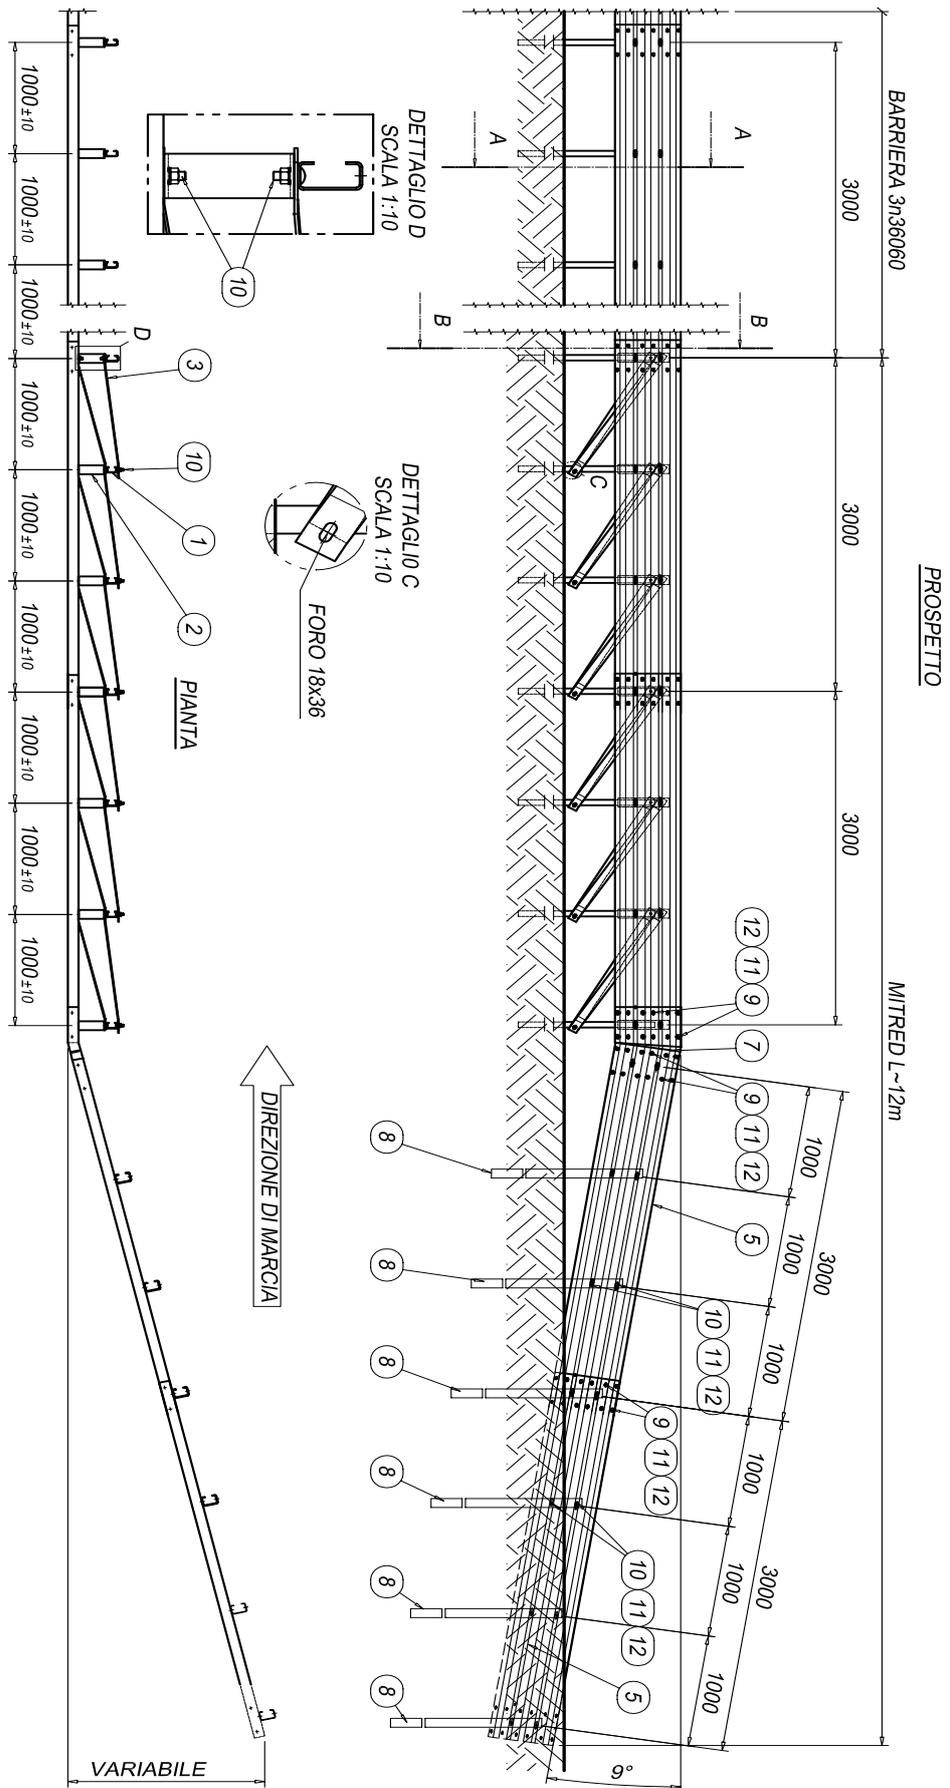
Vista d'assieme del terminale semplice utilizzato nel crash test.
